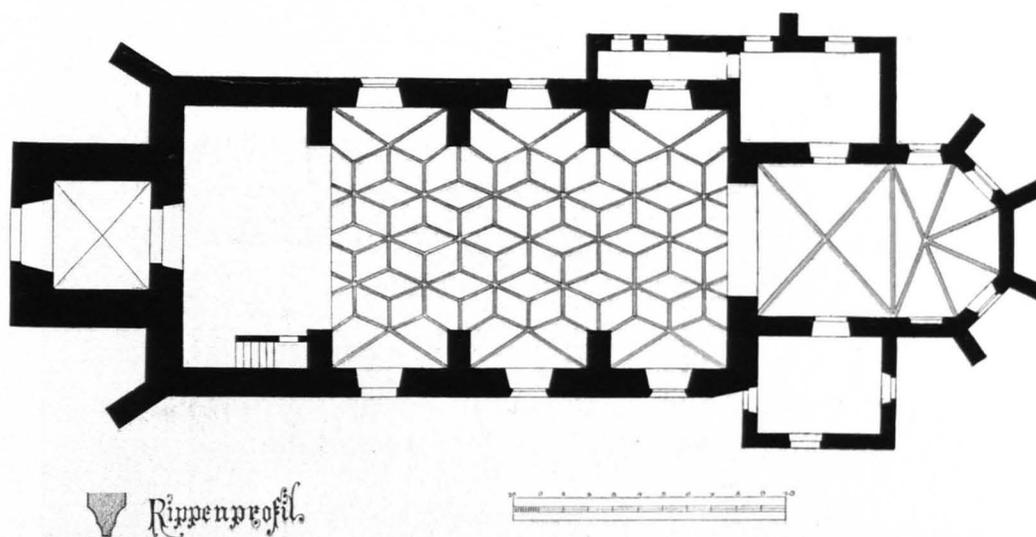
Wartberg, Pfarrkirche, Grundriß 1:300 (S. 141)
